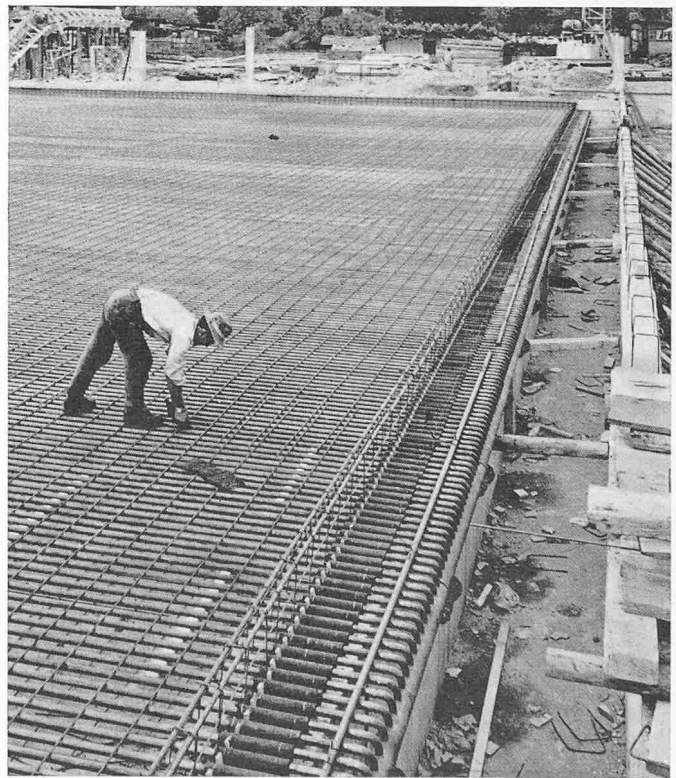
Kunsteisbahn Genf. Links Piste mit Kühlröhren auf Betonklötzen und Querarmierung, rechts Leitungskanal
